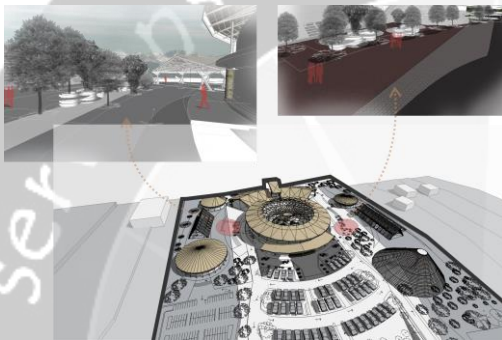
Aksonometri Eksterior Keseluruhan Bangunan
